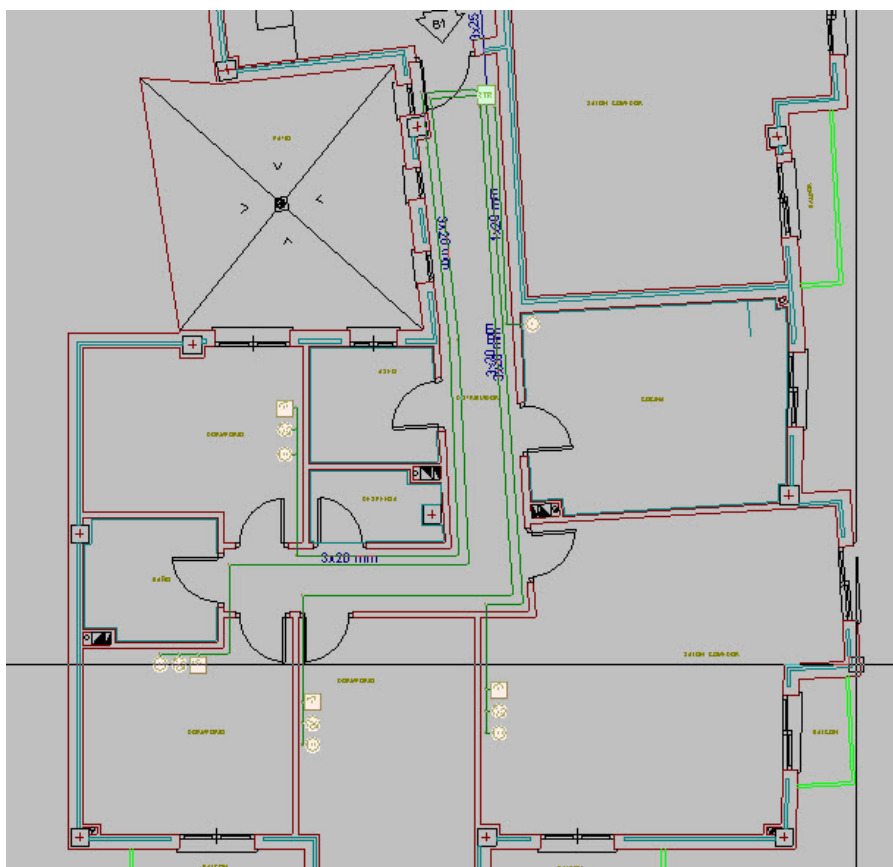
DETALLE Instalación ICT planta primera (dimensionada)
